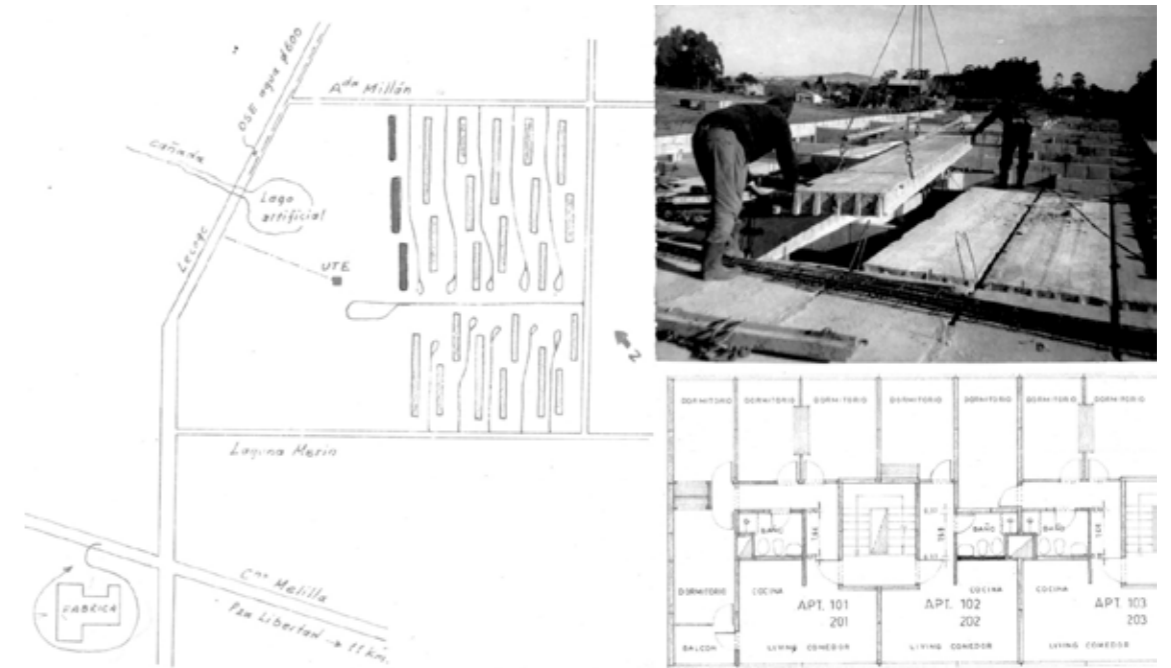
Esquema de implantación, planta tipo, y fotografías de obra del Complejo Millán. Fuente: Tesis 298. Biblioteca FADU-Udelar.
